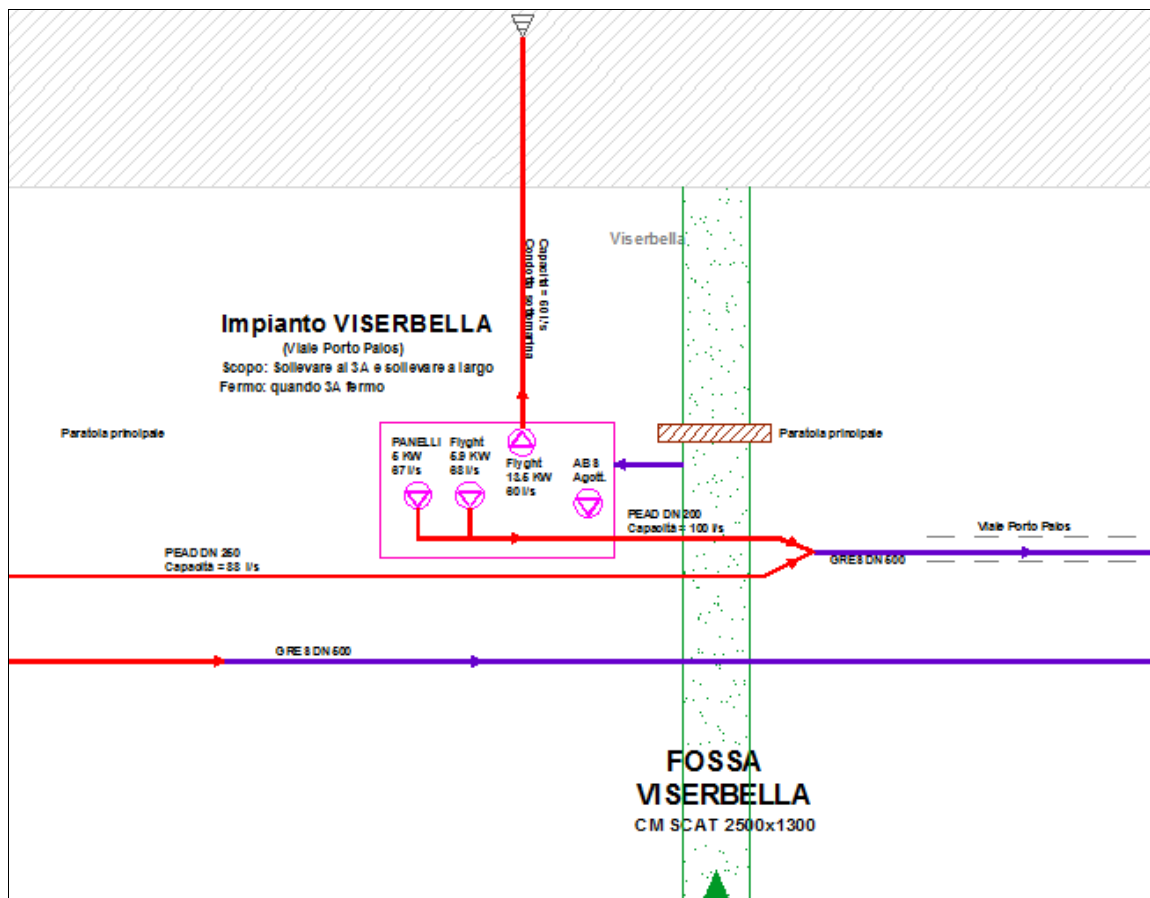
Schema impiantistico dell'impianto Viserbella
